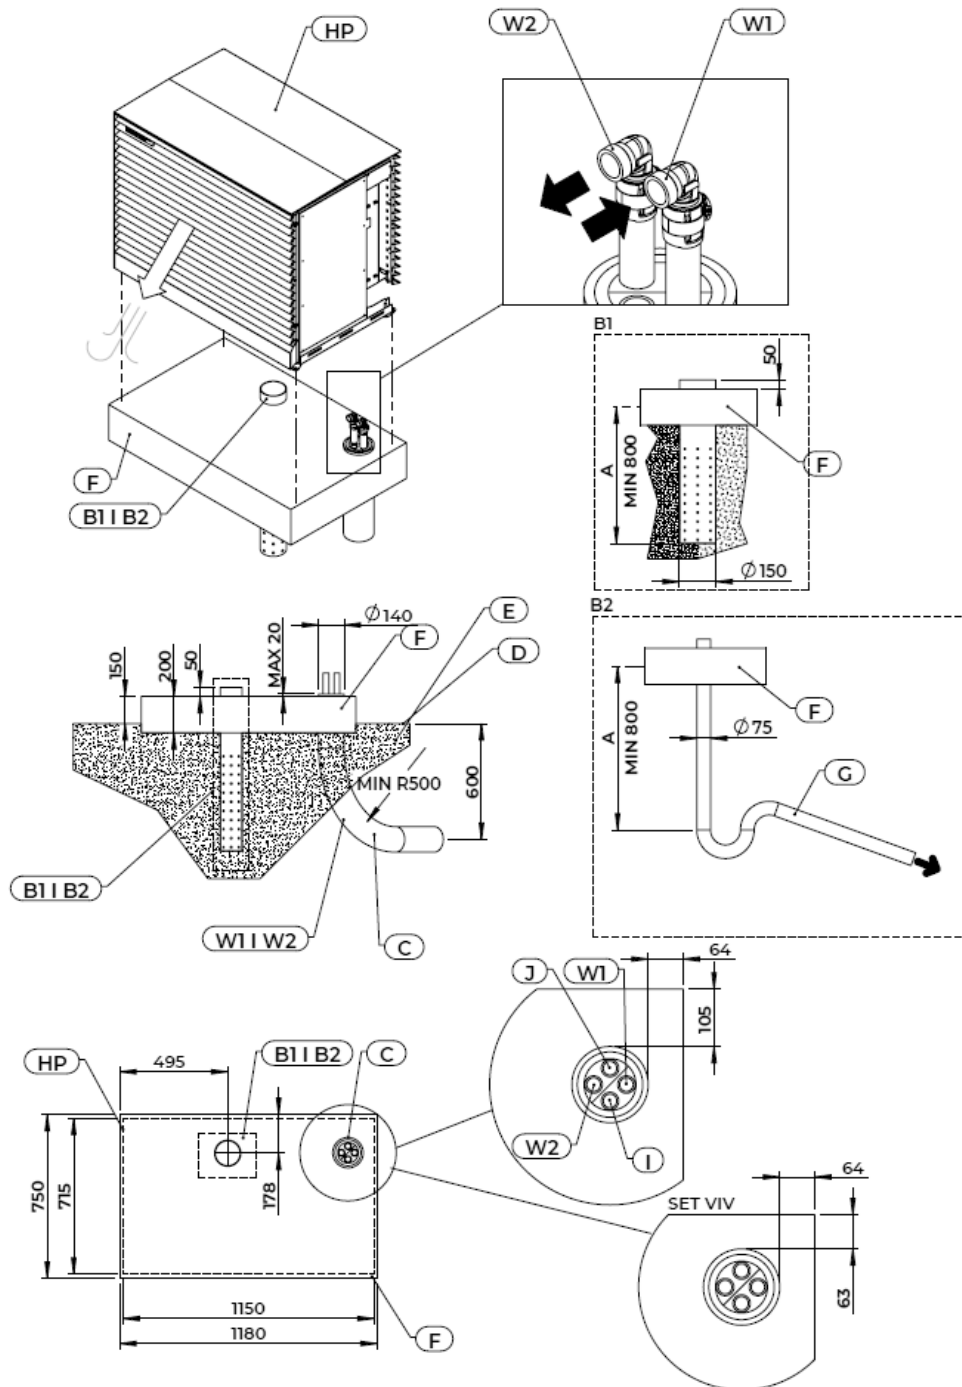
Betonfundament ADAPT 2 S, Rohranschluss unterirdisch
